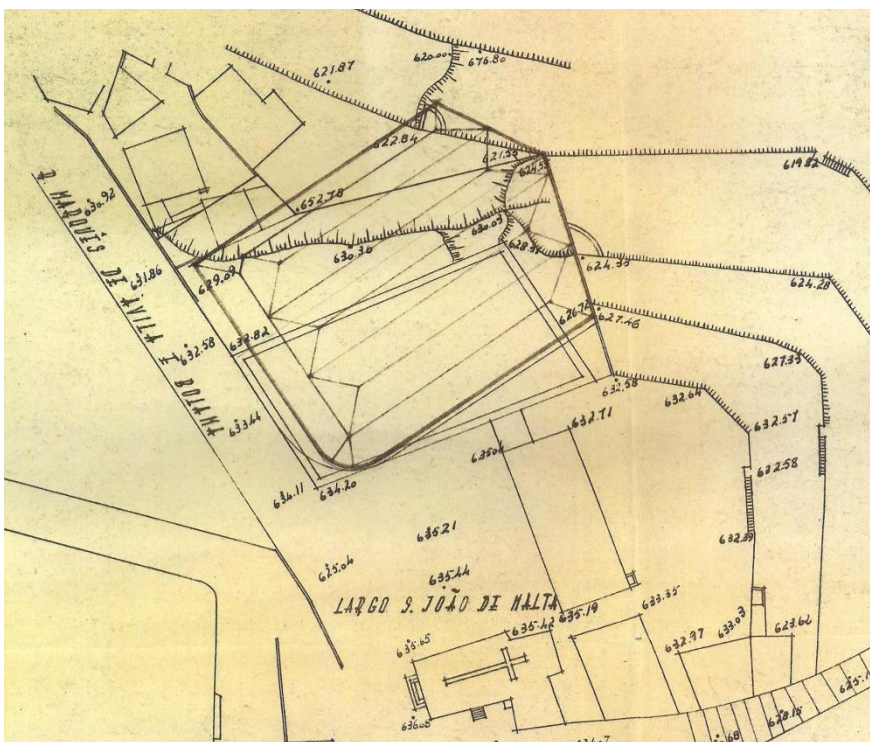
Implantação Existente, Escala 1/1000 (Arquivo Municipal Covilhã, 2019)
